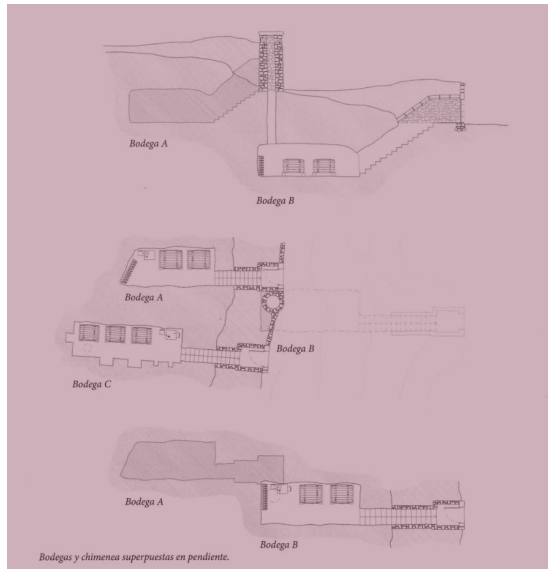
Esquema de dos bodegas excavadas con chimenea y superpuestas en pendiente. (Fuente: Jové, 2021).
